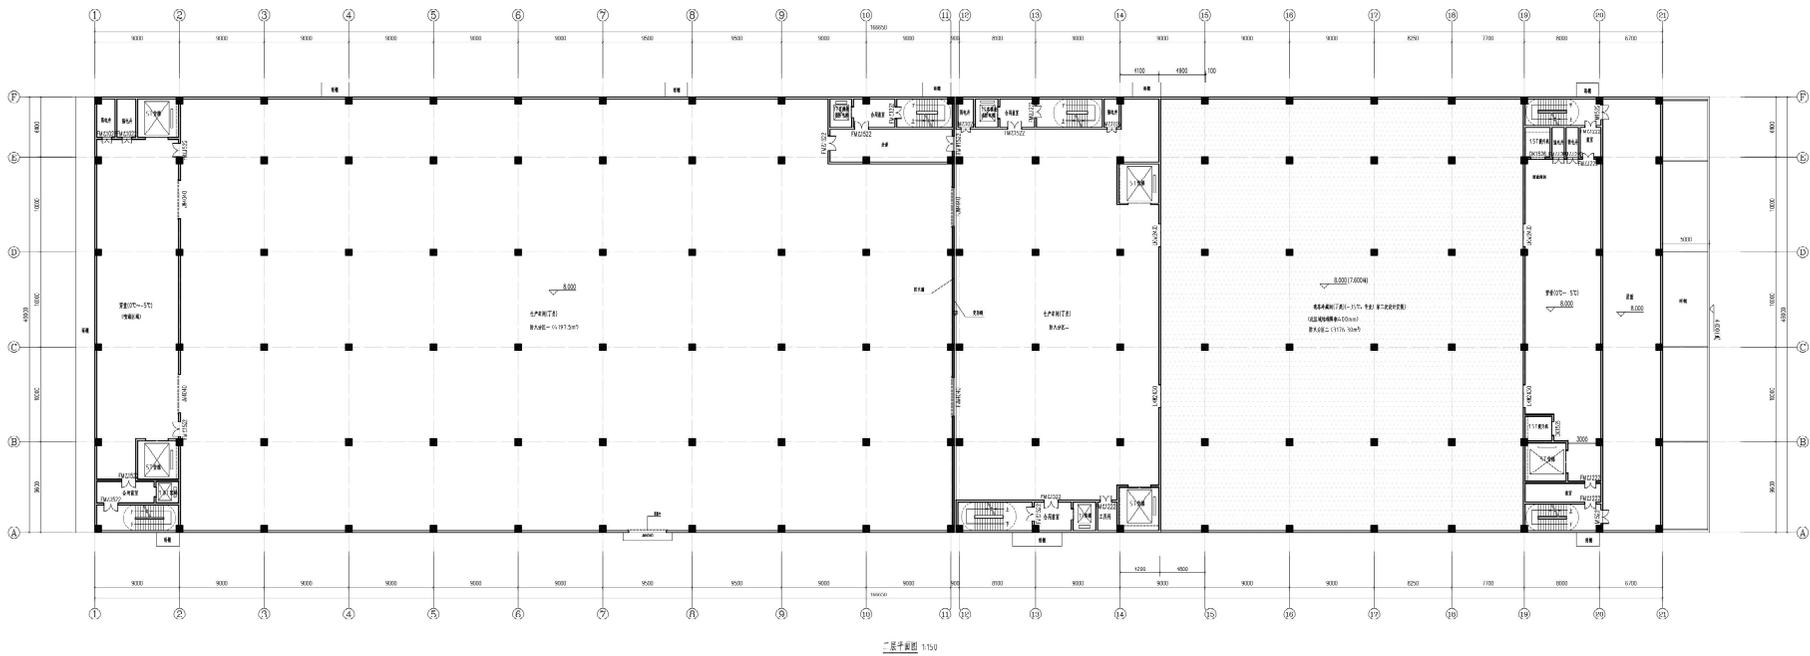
1#厂房二层及 2#厂房二层平面布置图
